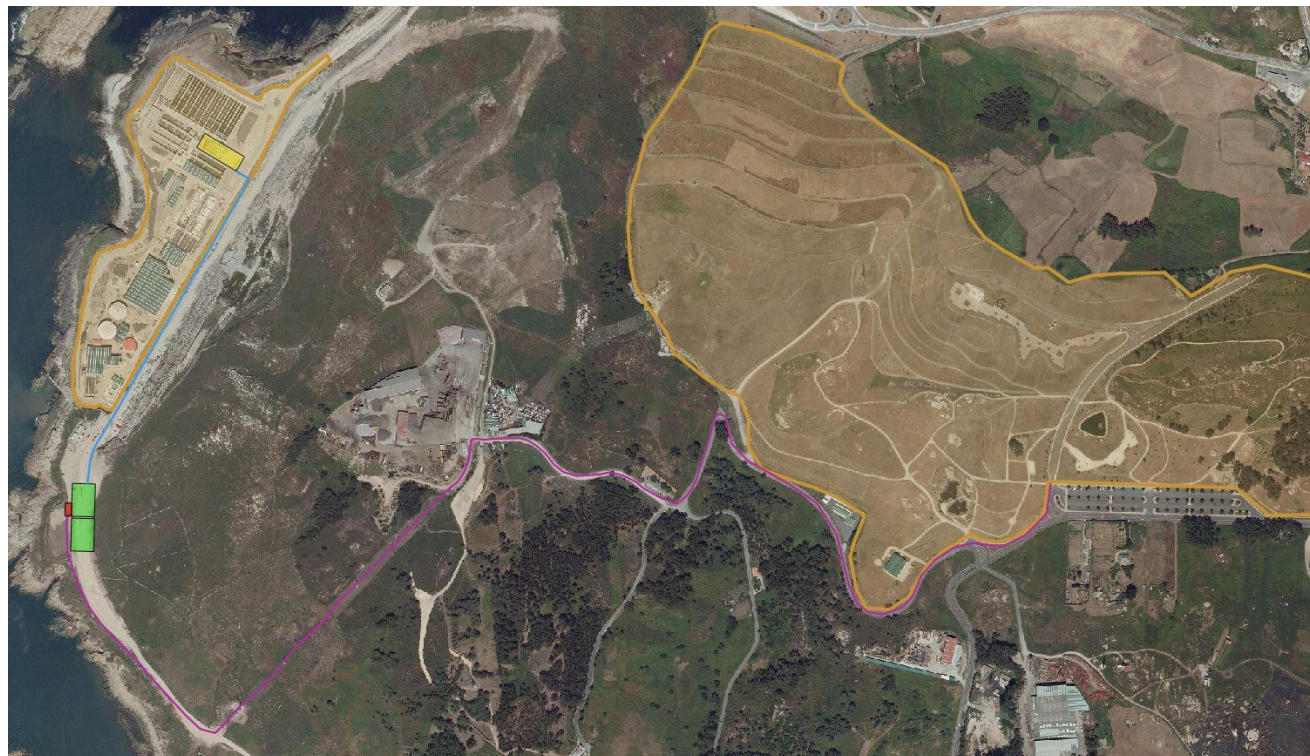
Planta general de trazado. En amarillo, la planta de tratamiento terciario en las instalaciones de E.D.A.R. Bens. En verde, los depósitos con su caseta de bombeo y cámara de llaves en rojo. La conducción de distribución y el sistema en alta se representan en malva y azul, respectivamente.
